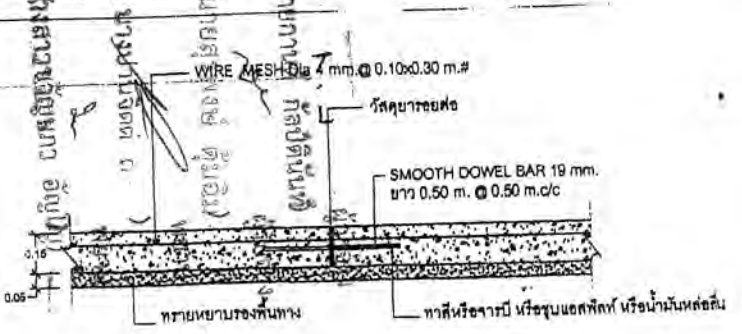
CONSTRUCTION JOINT (รอยต่อเพื่อการหดตัว)
